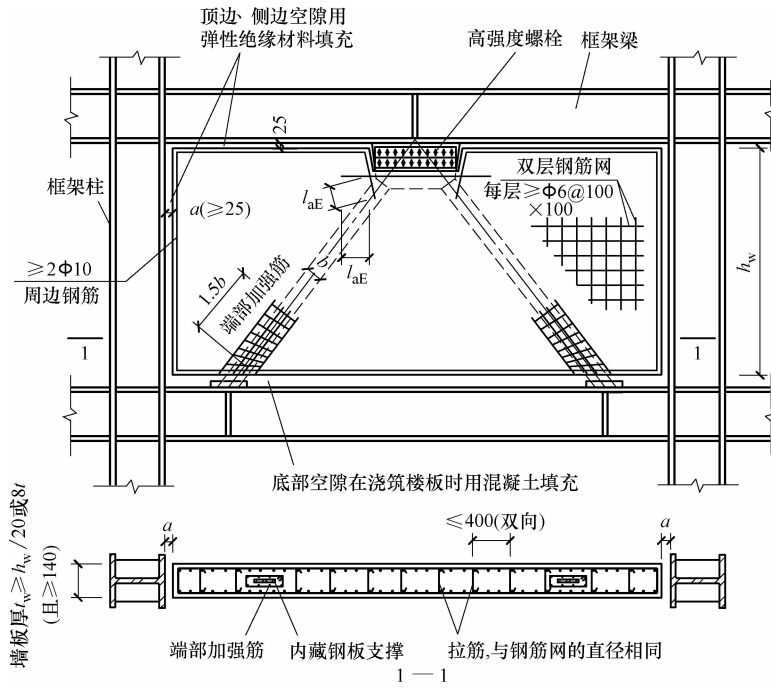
内藏钢板支撑剪力墙的混凝土墙板构造
